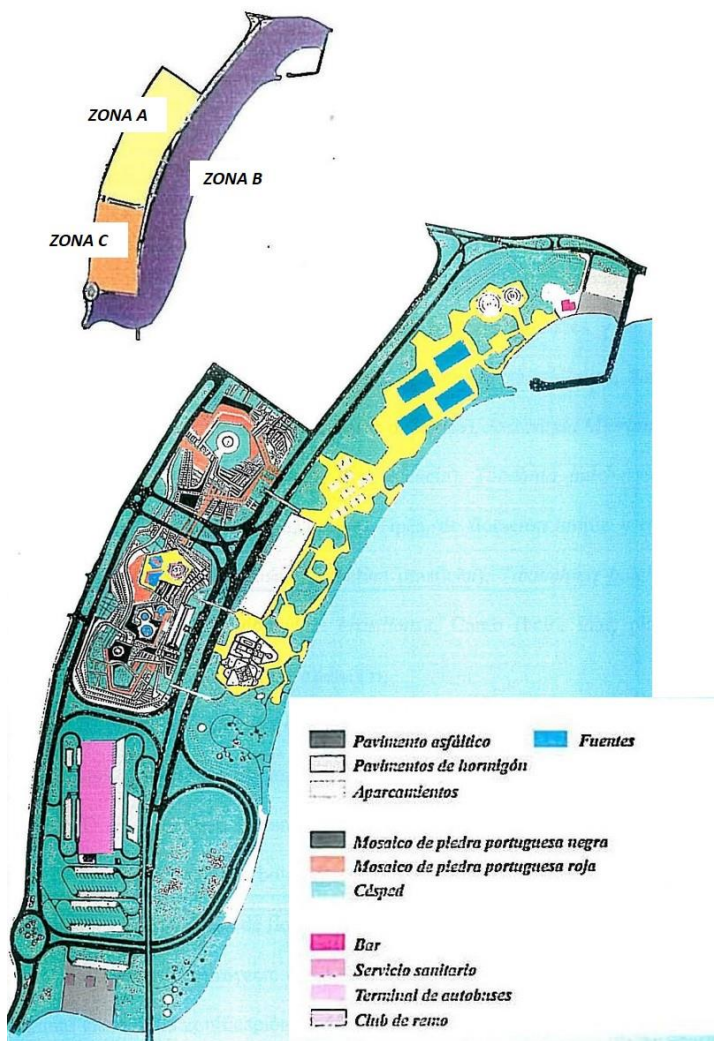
Plano geral do projeto de Roberto Burle Marx.
